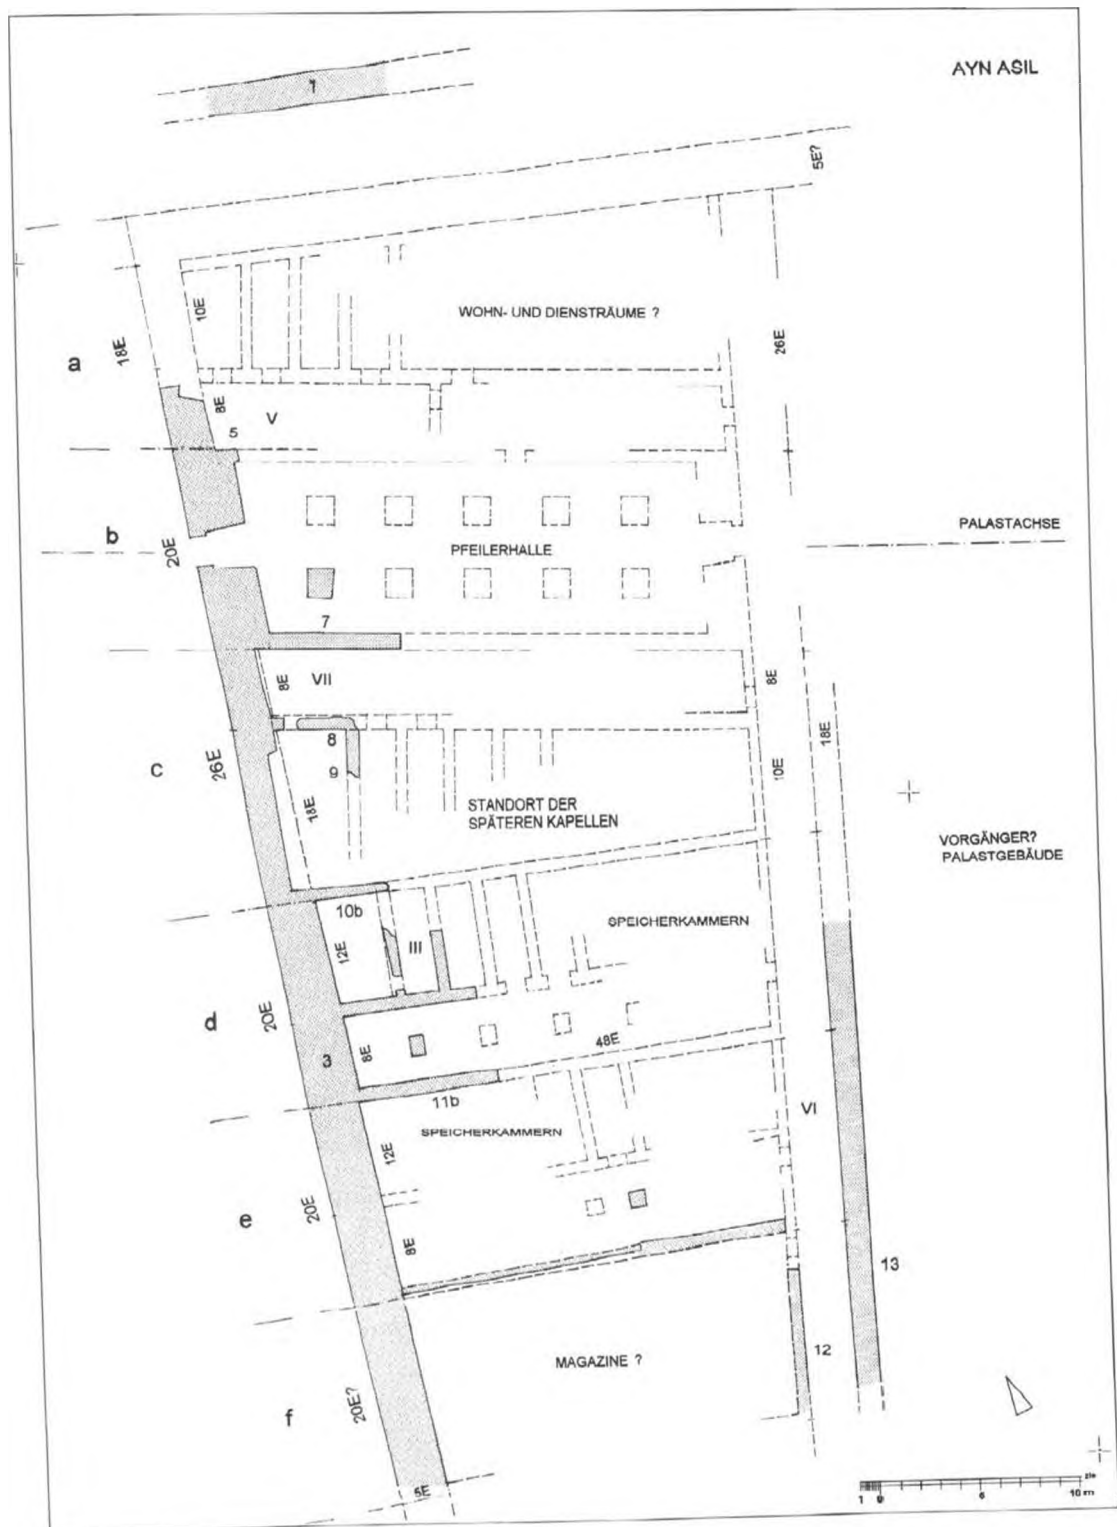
Rekonstruktion der ursprünglichen Bebauung in der 2. Stadterweiterung (Palastareal Baustufe I)
